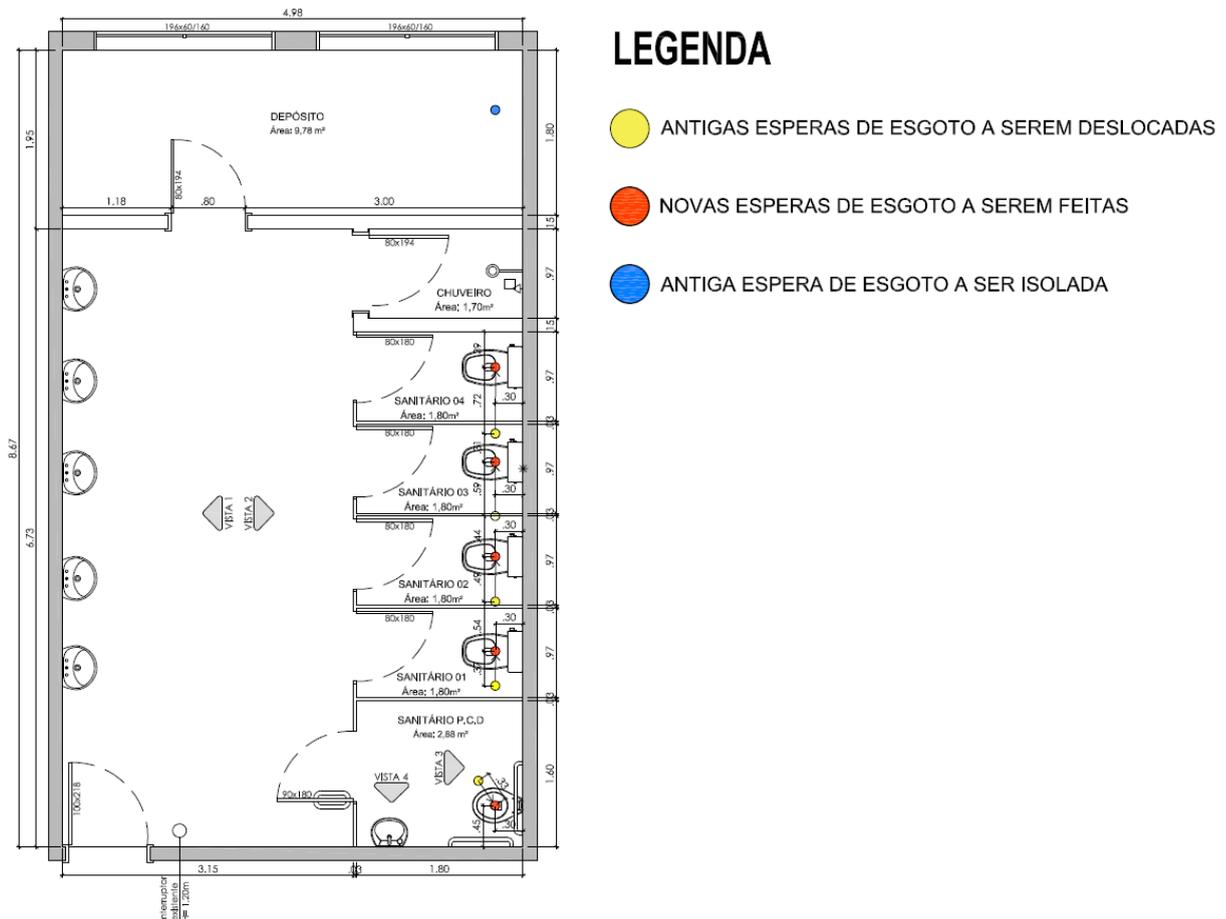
Planta baixa com a indicação das alterações hidráulicas
